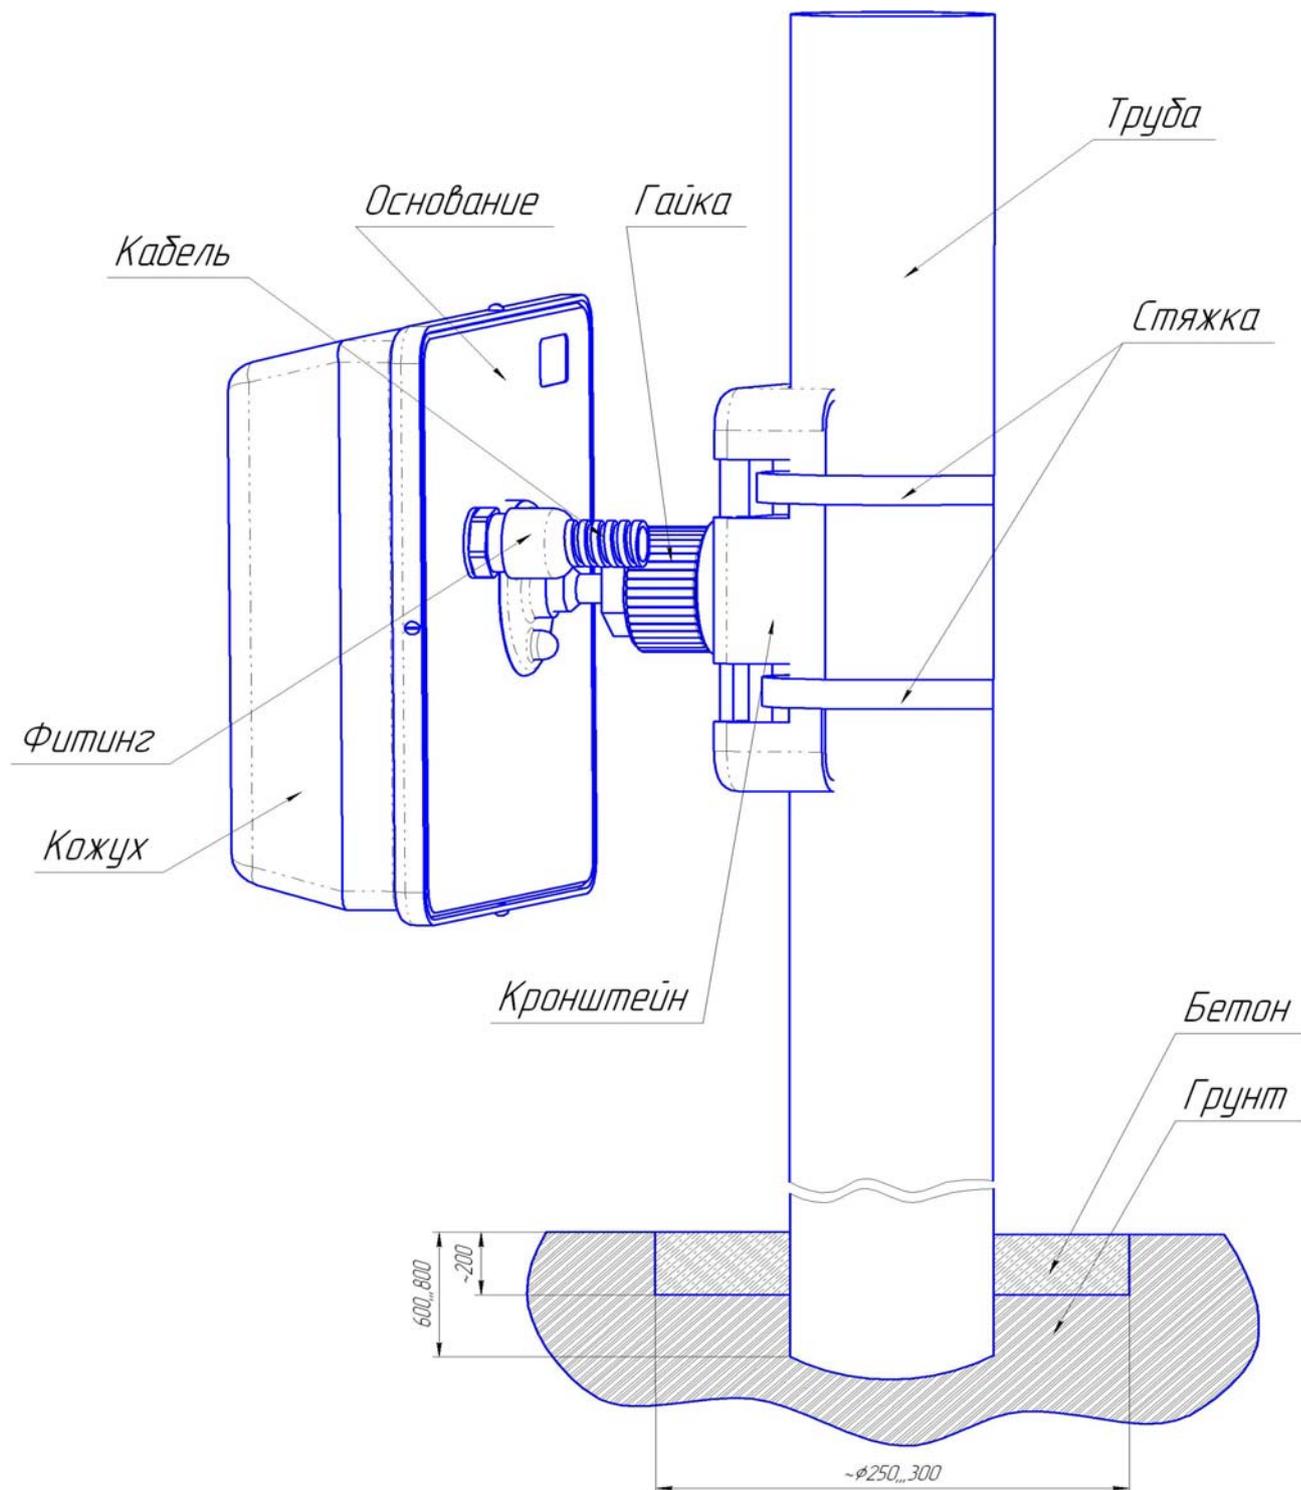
Внешний вид блока ПРМ/ПРД
